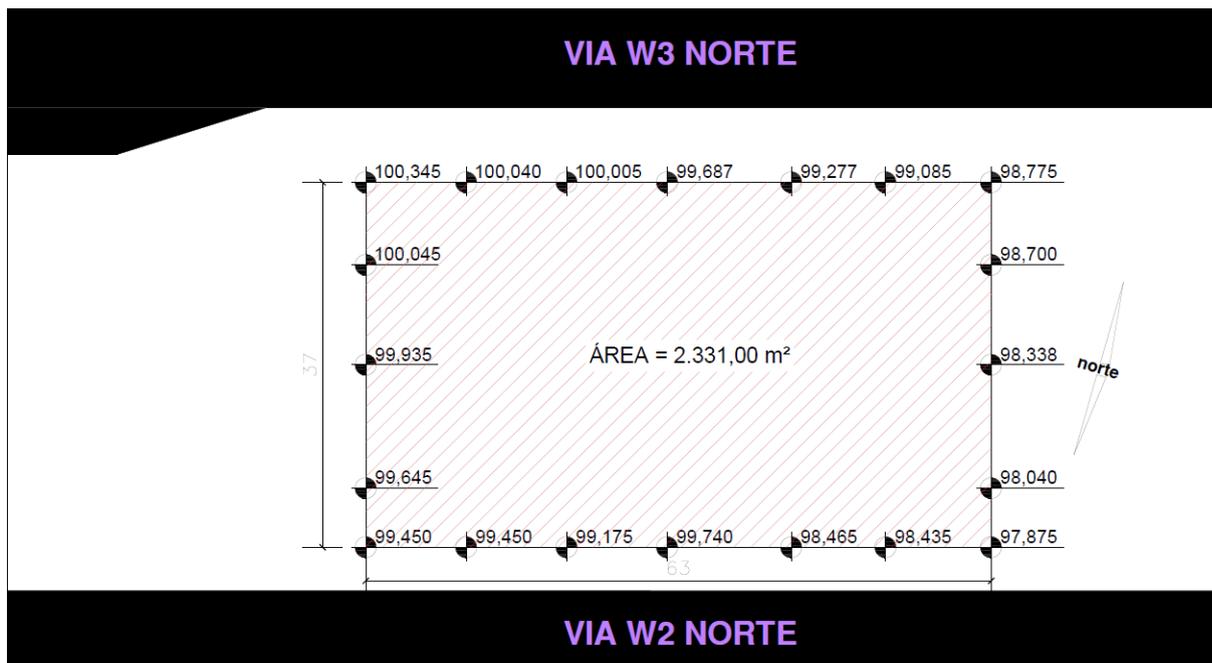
Terreno a ser considerado para a elaboração do projeto hachurado. Terreno com área de 2.331,00 m². Fonte: Própria, 2025.
